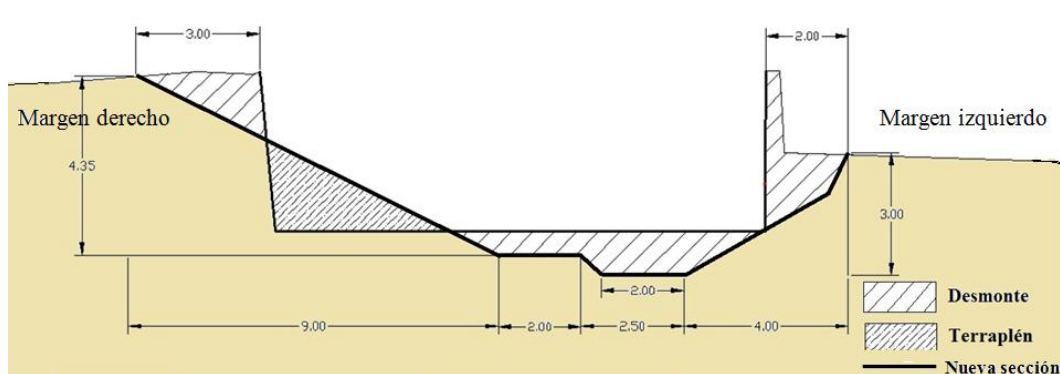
Perfil tipo para el tramo comprendido entre las secciones 130 y 20. Elaboración propia
